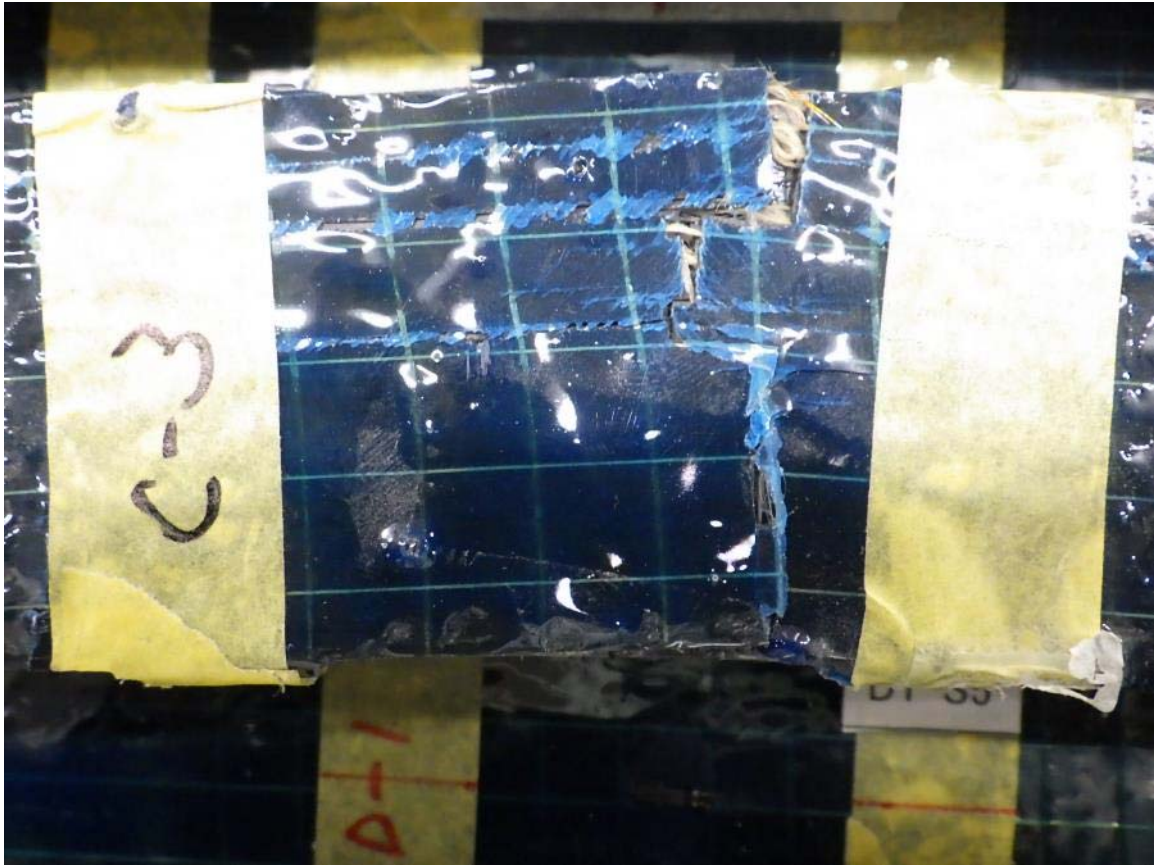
曲げ載荷試験後における CFRP の破壊状況 (試験体 C-b 幅方向 裏)
